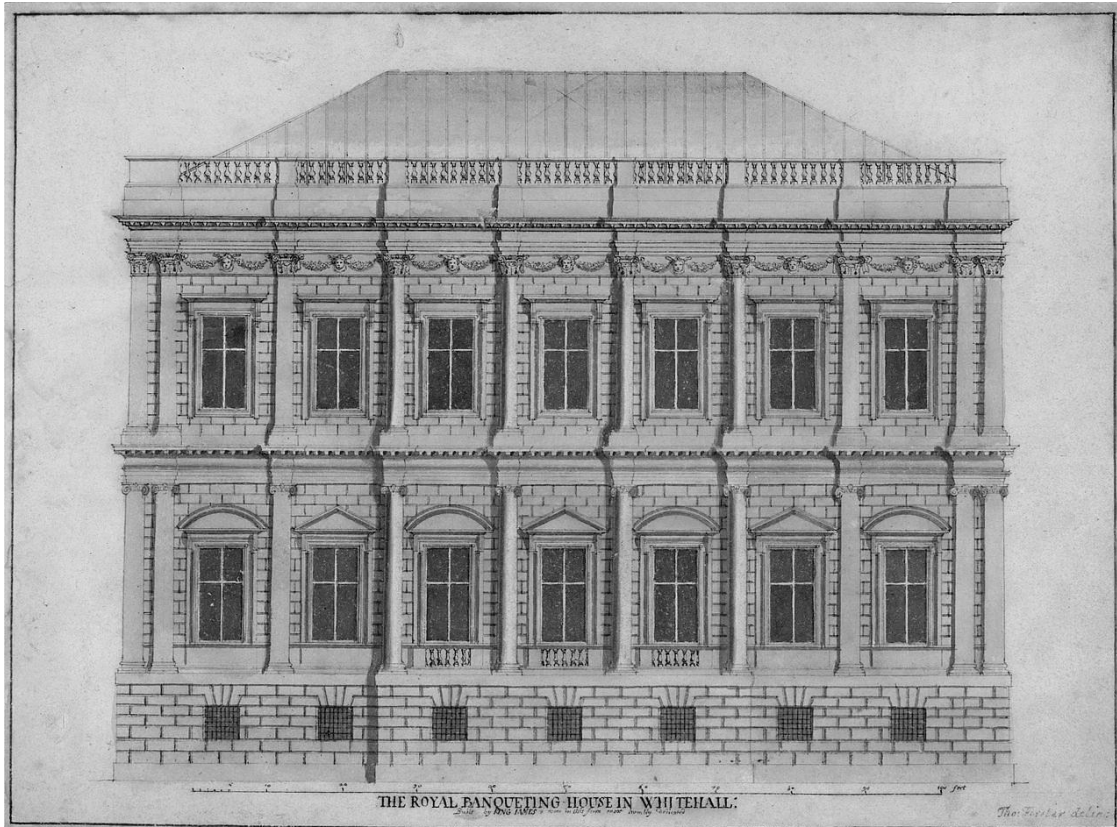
Inigo Jones, *Banqueting House*, Hauptfassade, Whitehall/London, 1619 – 1622
